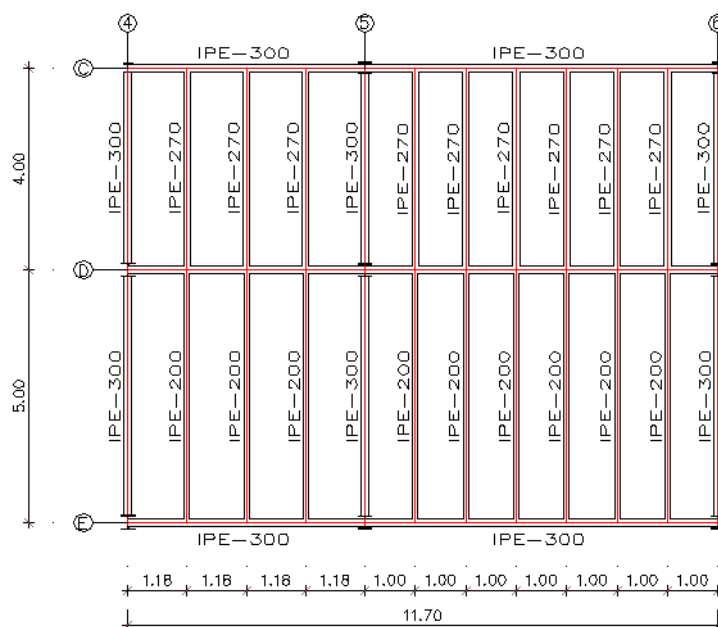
Planta com a Geometria das Vigas Interiores do Piso 3 Alinhamentos 4, 5 e 6.
